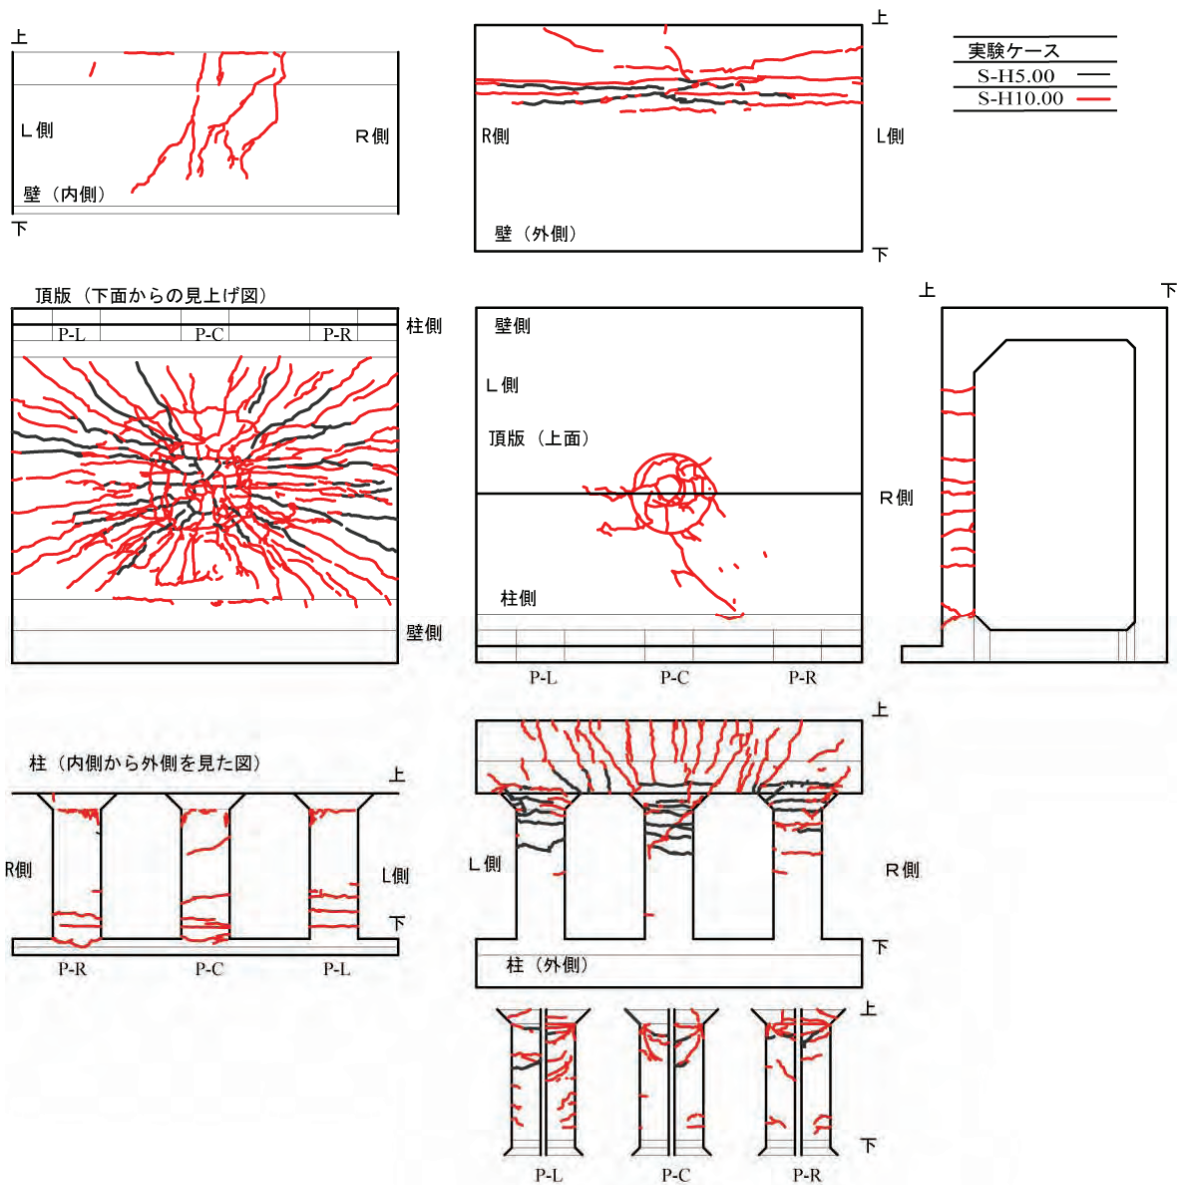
頂版のひび割れ状況(緩衝工無し)
